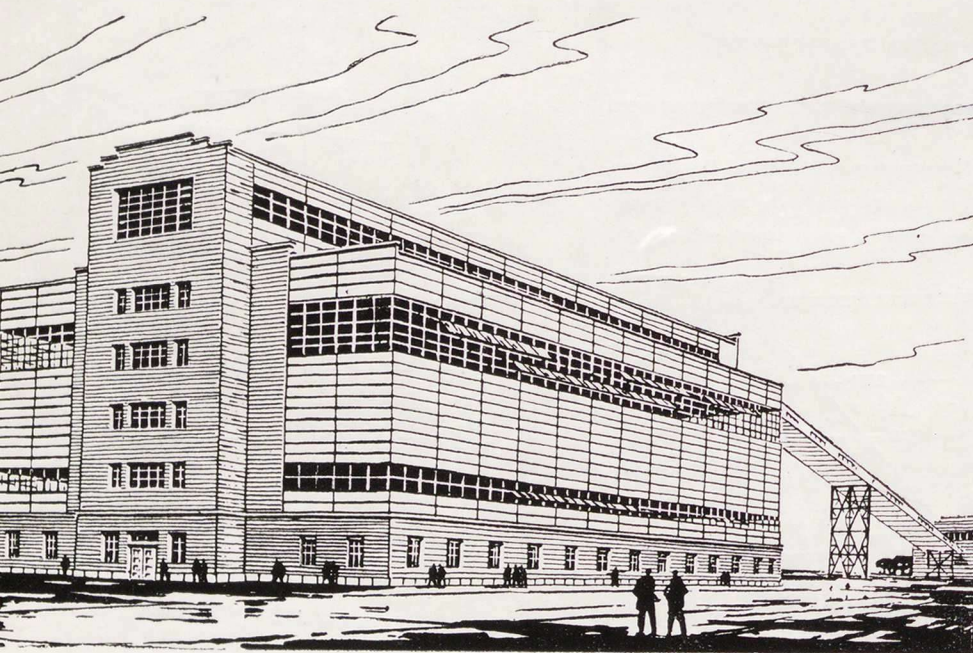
Ново-Криворожский горнообогатительный комбинат. Корпус дробления. Перспектива
